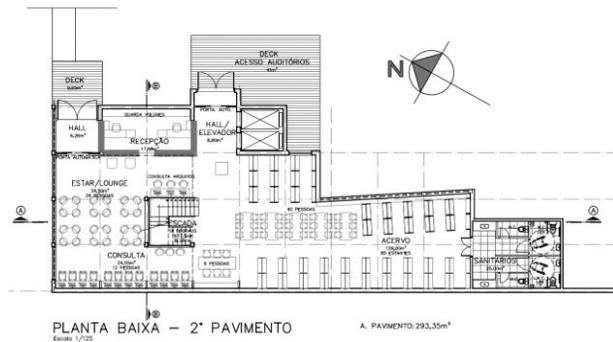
Planta Baixa 2º Pavimento - Fonte: Triple Arquitetura, 2013.
